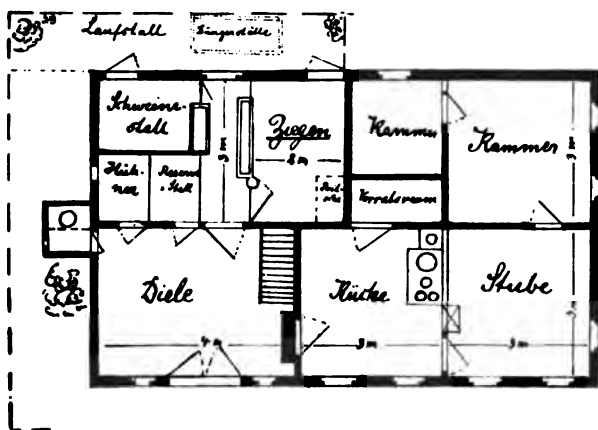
Grundriß eines Hauses mit Stallanlage für Kleinvieh-, insbesondere Ziegenhaltung; Maßstab 1:100.
